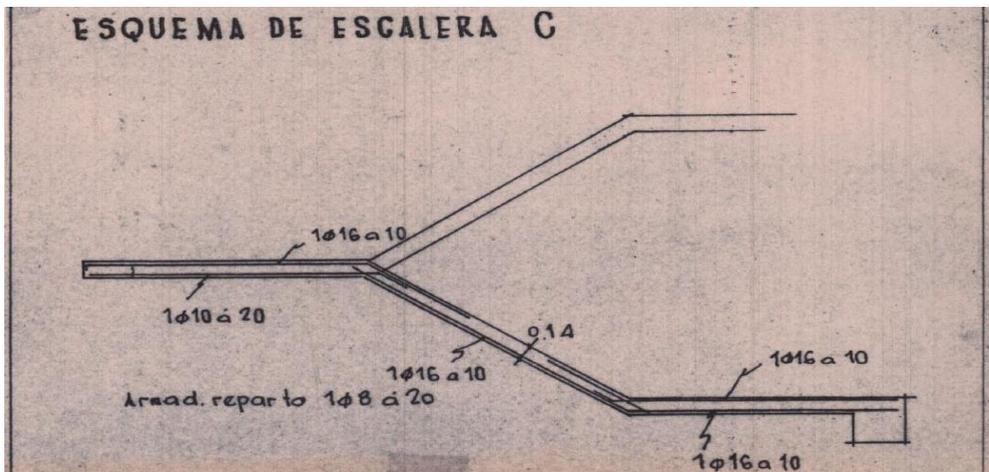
Destalle losa de escalera. Fuente: Archivo personal de Cortés.
